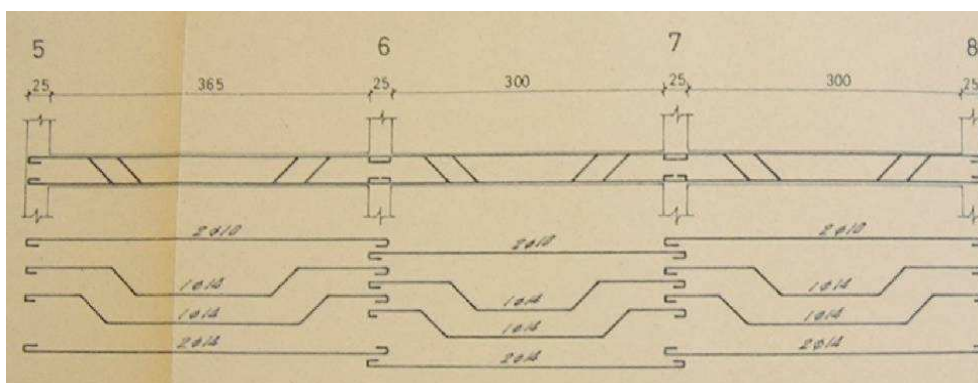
Plano despiece de viga, Edificio ficha 92C.003, 1966.
